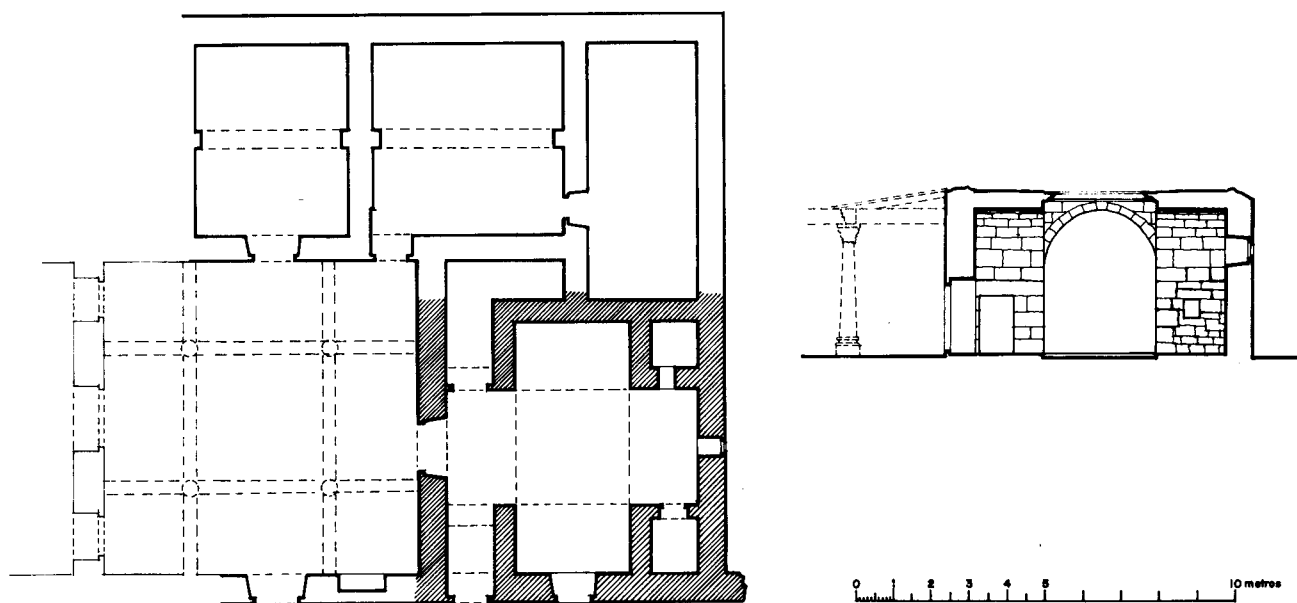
Planta y sección del pretorio de Umm al-Īmāl.
